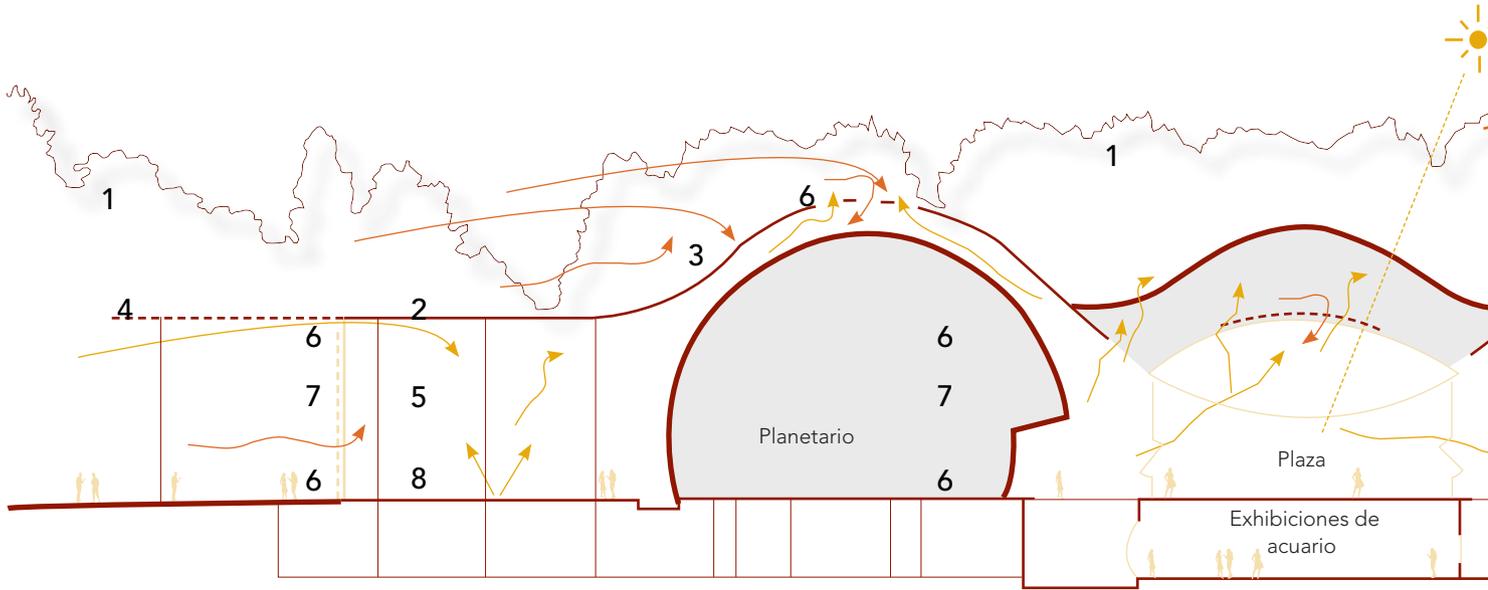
Distribución de espacios de la planta arquitectónica del museo
